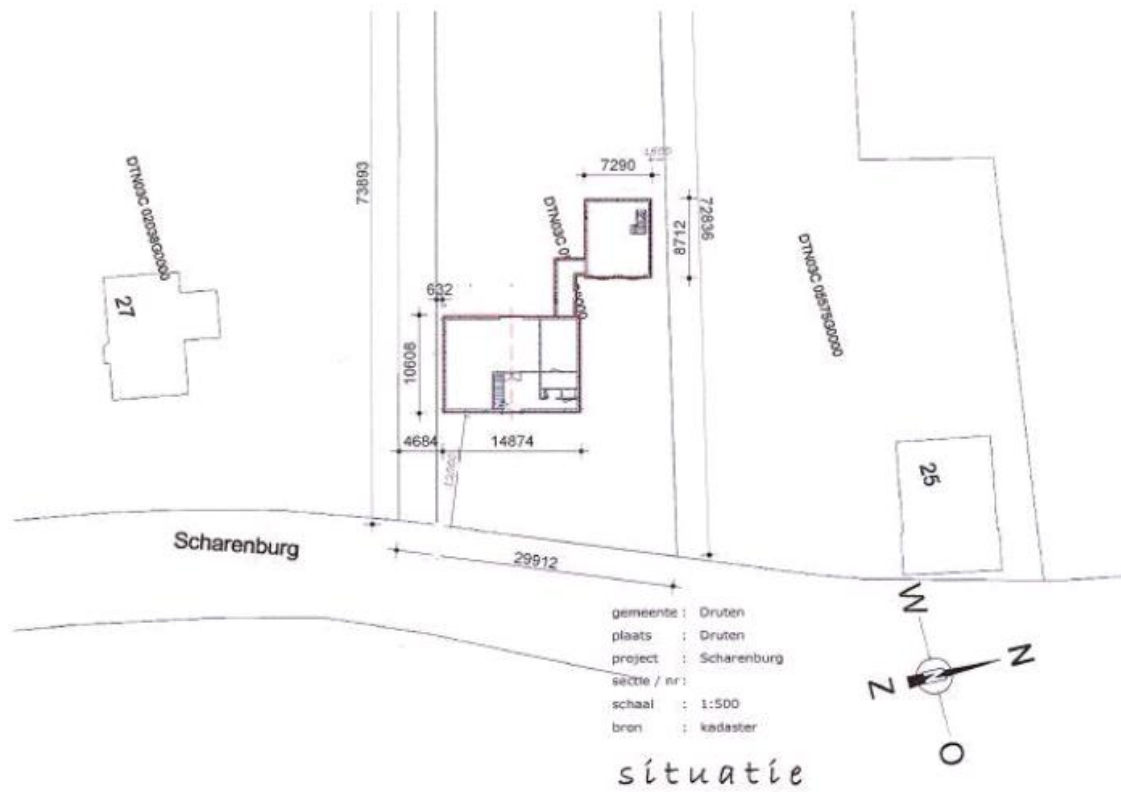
(ook volgende blz) Toekomstige situatie in de verschillende plangebieden (overgenomen uit de verschillende Ruimtelijke onderbouwingen zoals geleverd door de opdrachtgever).
